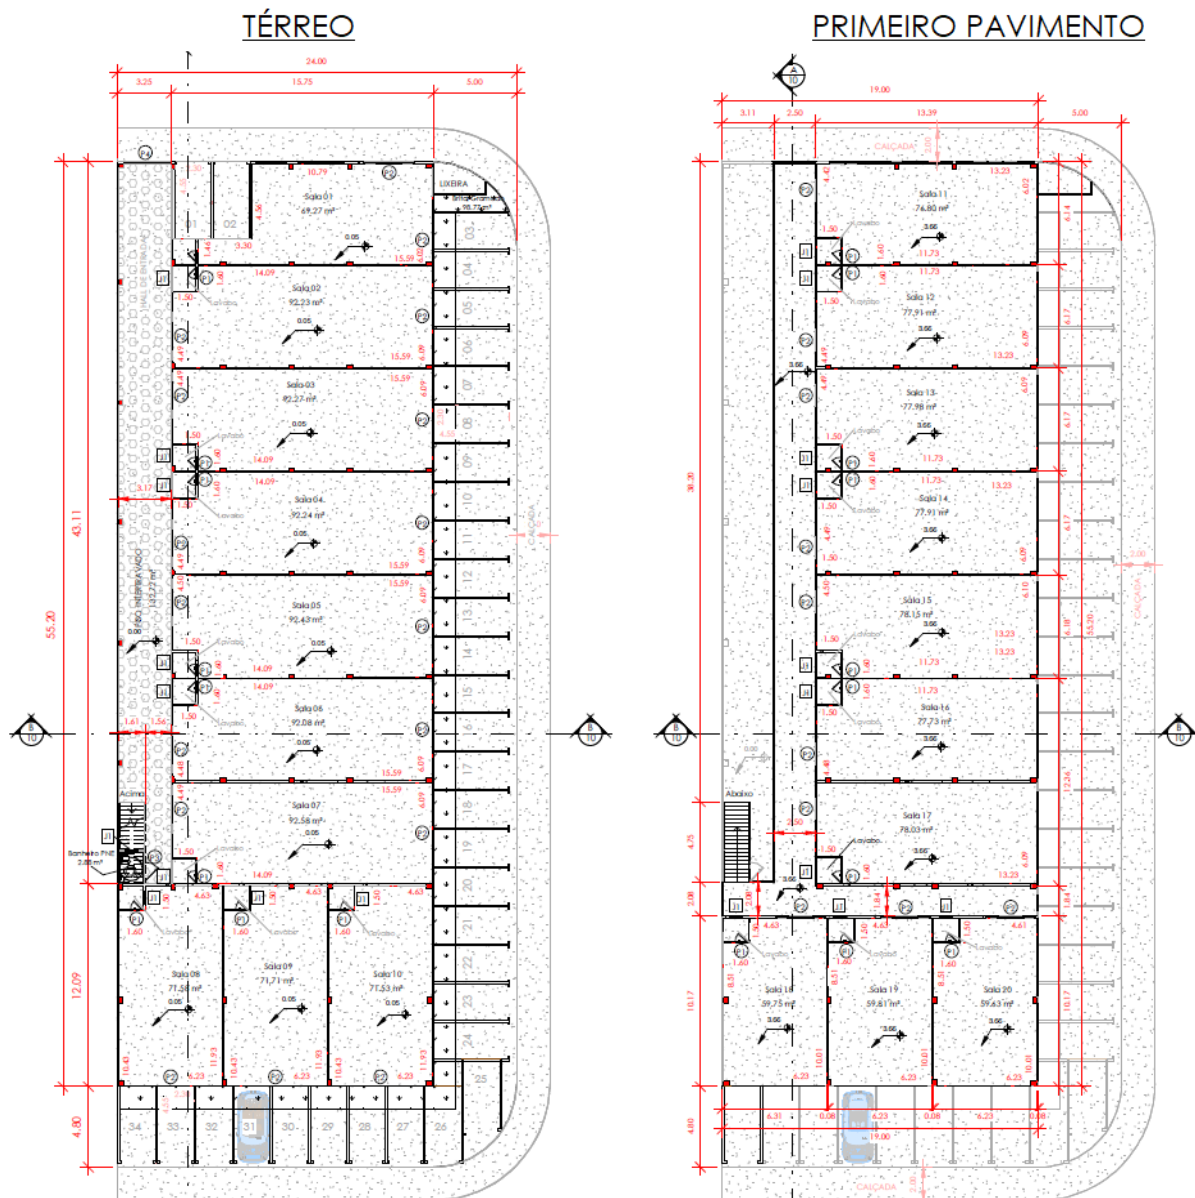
Plantas baixas do térreo e do primeiro pavimento. Fonte: Projeto de arquitetura proposto
